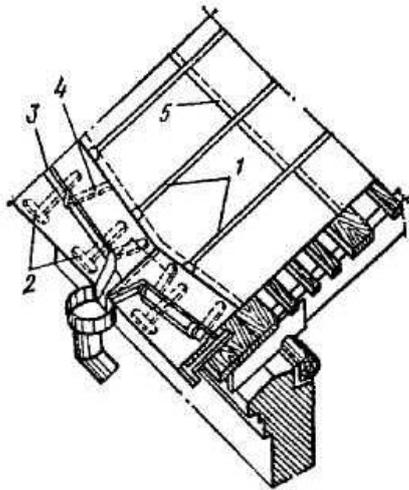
Фрагмент стальной кровли: 1 – стоячий фальц; 2 – костьль; 3 – желоб; 4 – крюк; 5 – лежачий фальц
